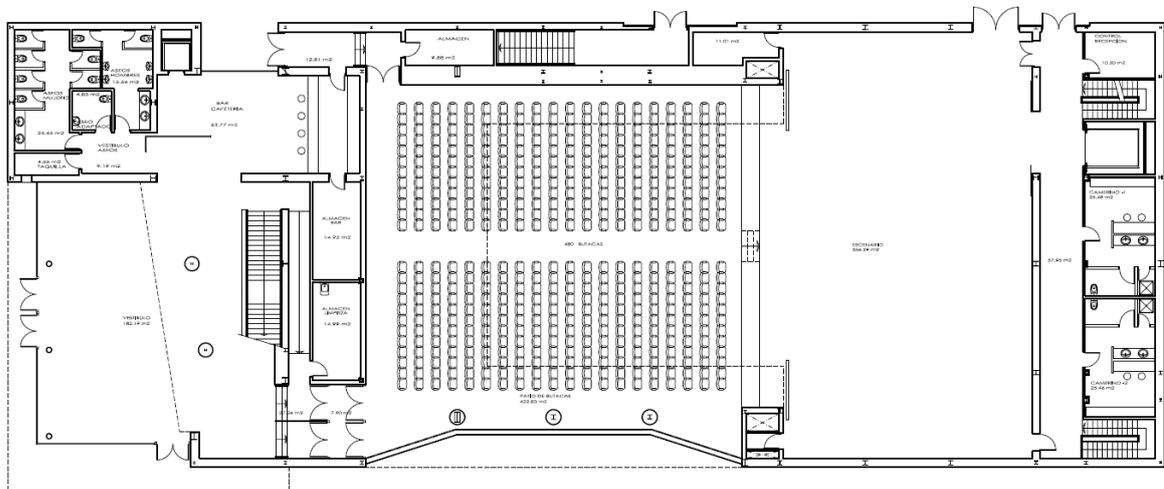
Planta baja (Magín Ruíz de Albornoz)
